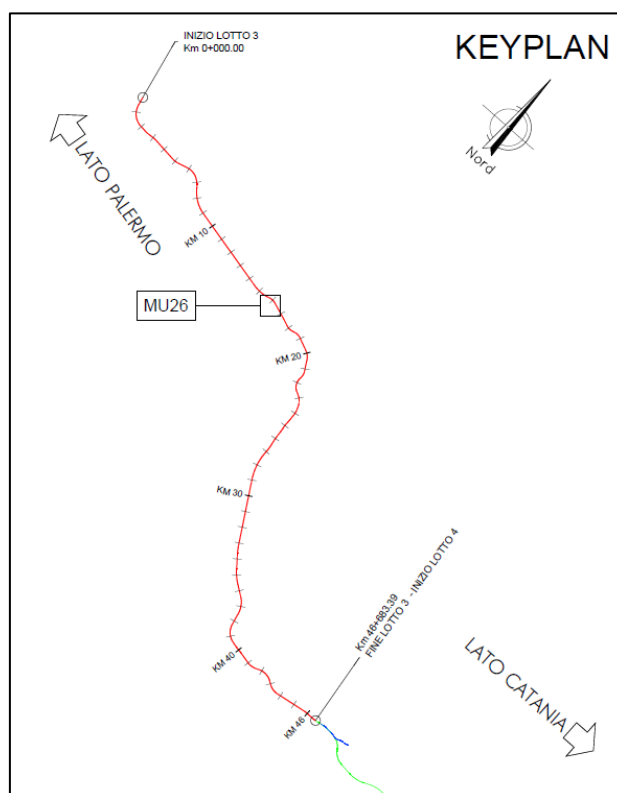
Posizione planimetrica dell'opera MU26.
